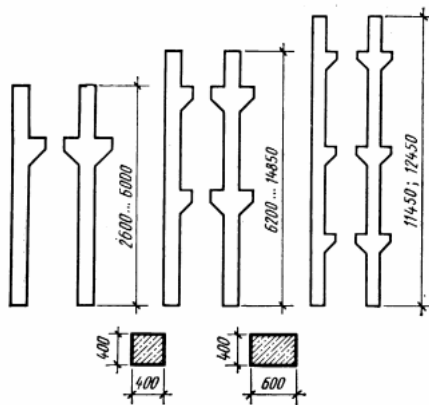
Типи залізобетонних колон багатоповерхових промислових будівель при оперті ригелів на консолі колон
